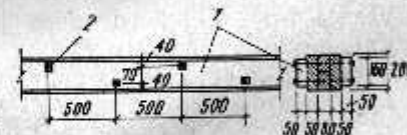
Схема усиления дощатой фермы треугольного очертания
